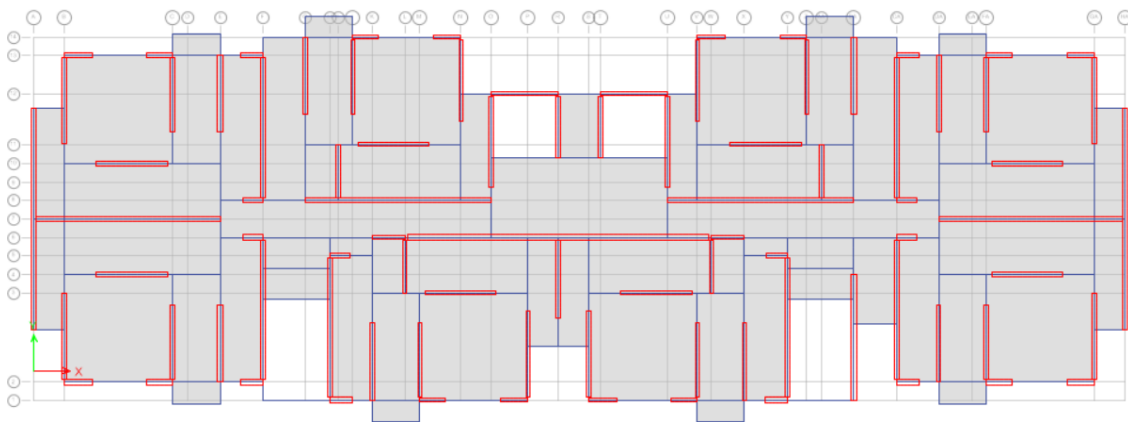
Distribución en planta de muros estructurales. Modelo con muros NO vinculados. Extraída del programa ETABS.
